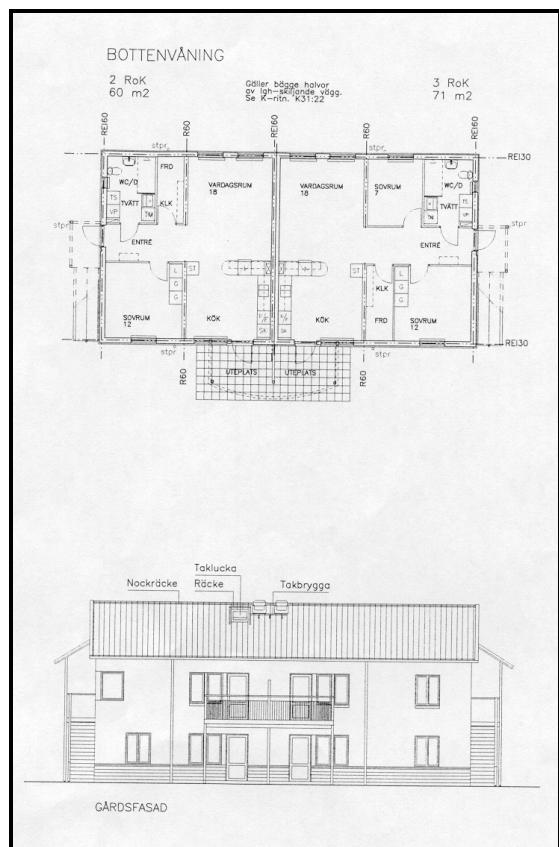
Typvåningsplan och fasad Ytterby centrum.
